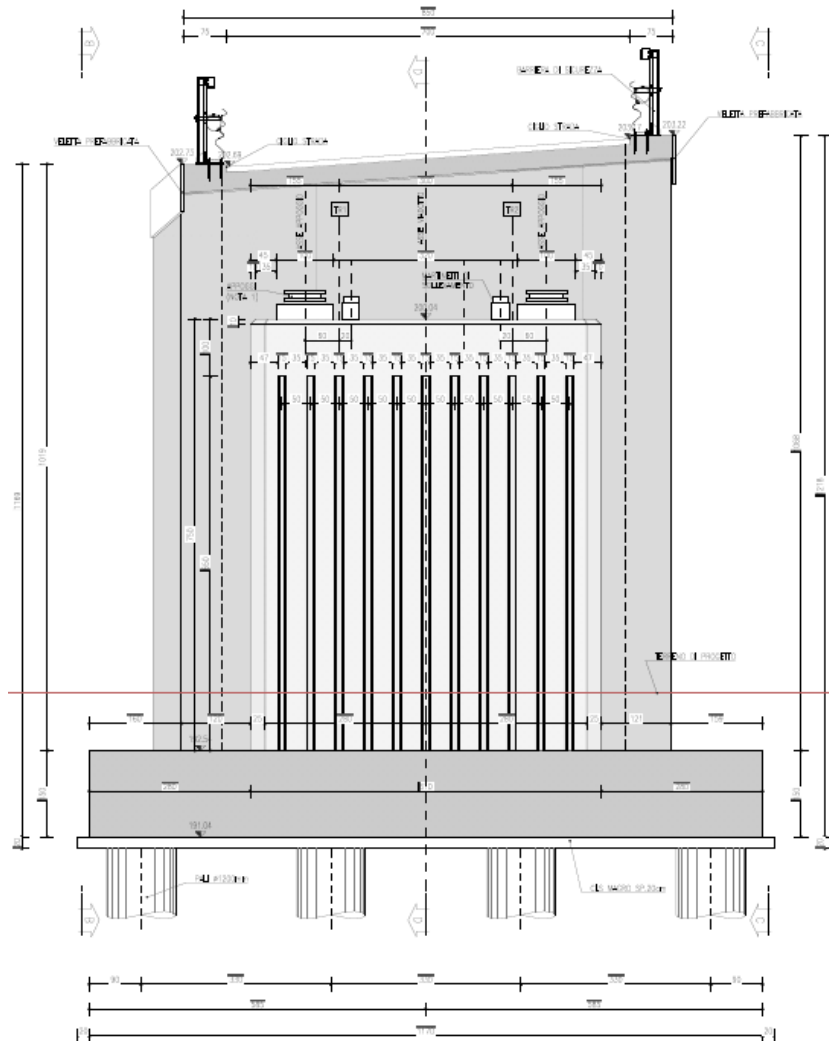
Spalla 1 – carpenteria elevazioni
